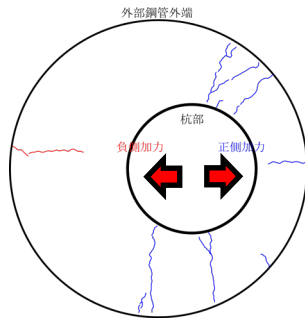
ひび割れ状況 (パイルキャップ下端)
